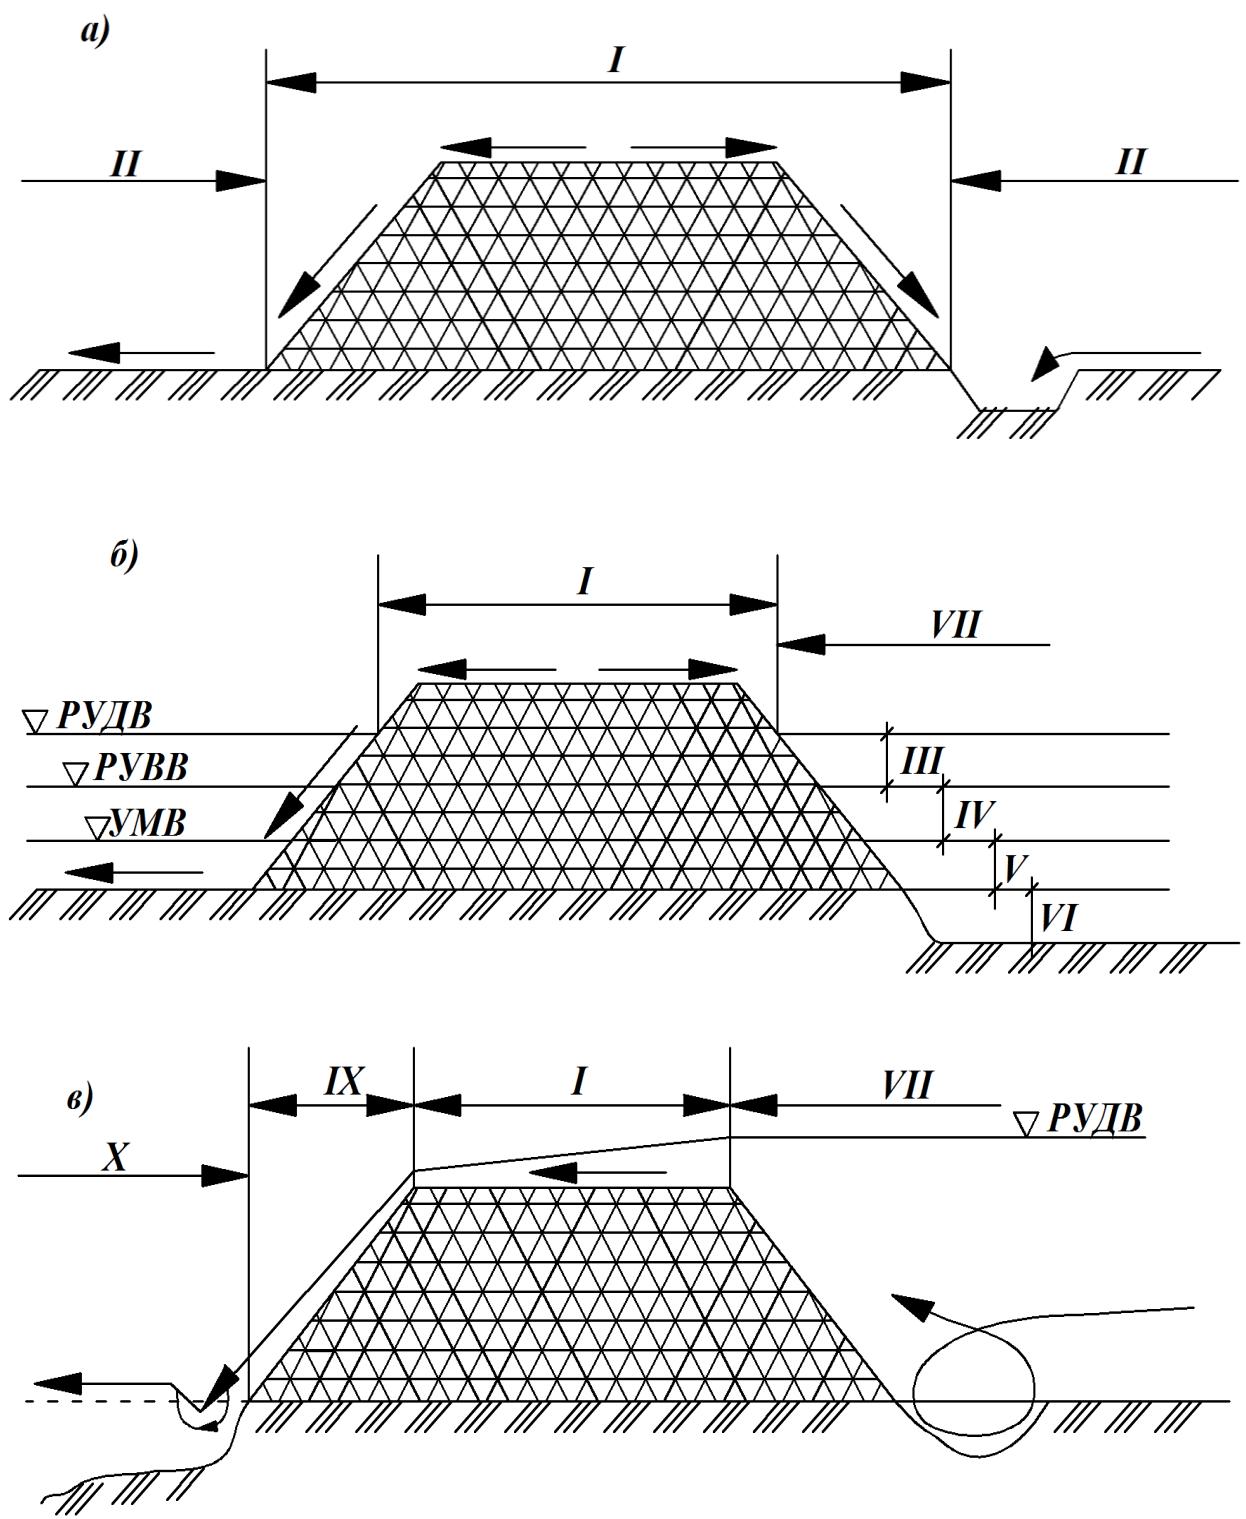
Схема увлажнения земляного полотна дорожной насыпи
